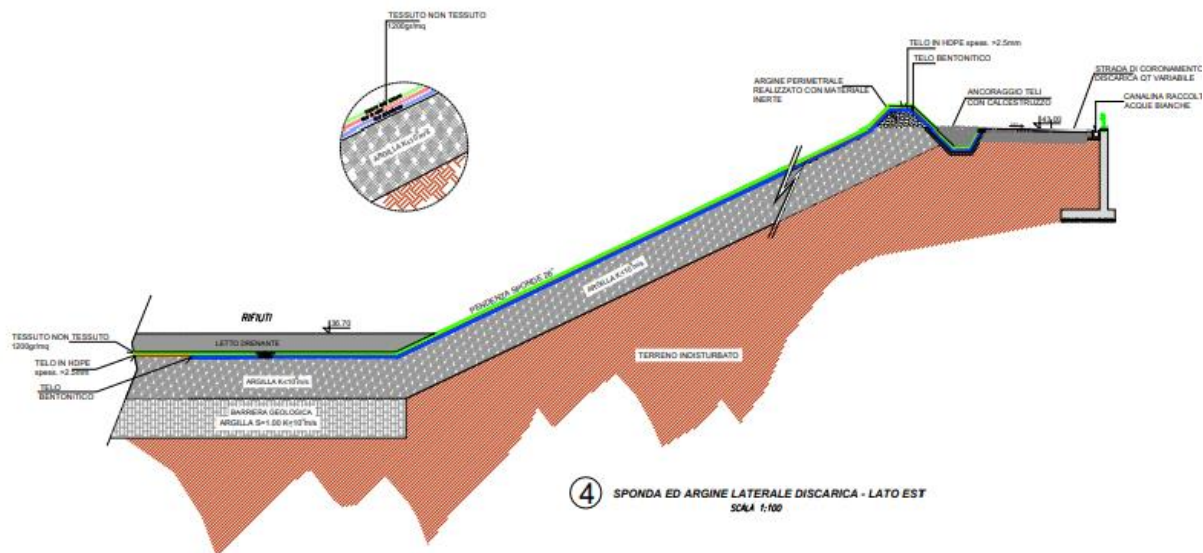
Particolare sezione Sponde – 27\_tav\_14s\_Particolari argini
